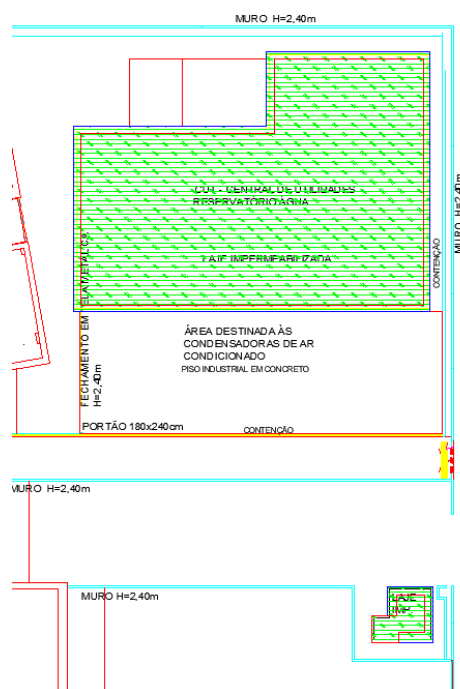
Área considerada para pavimento final (CUT e Guarita 2)
